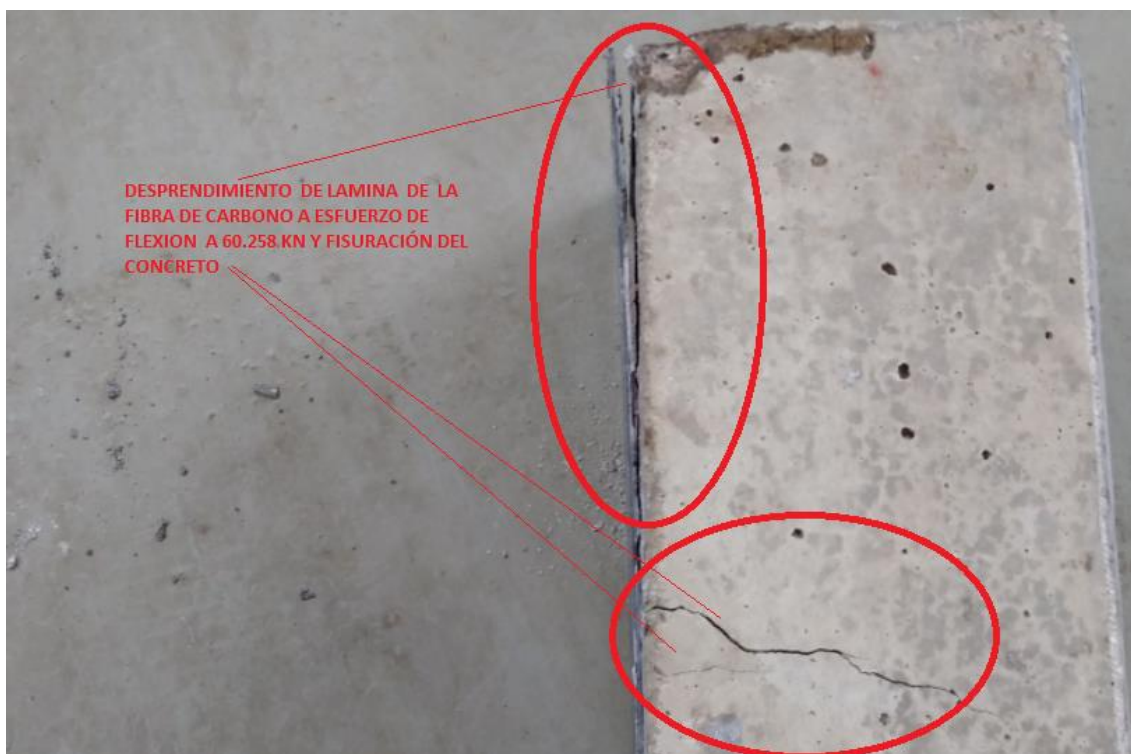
Desprendimiento de Lámina de FRP y Fisuras a Carga de Rotura 60.258 kN. Fuente propia.
